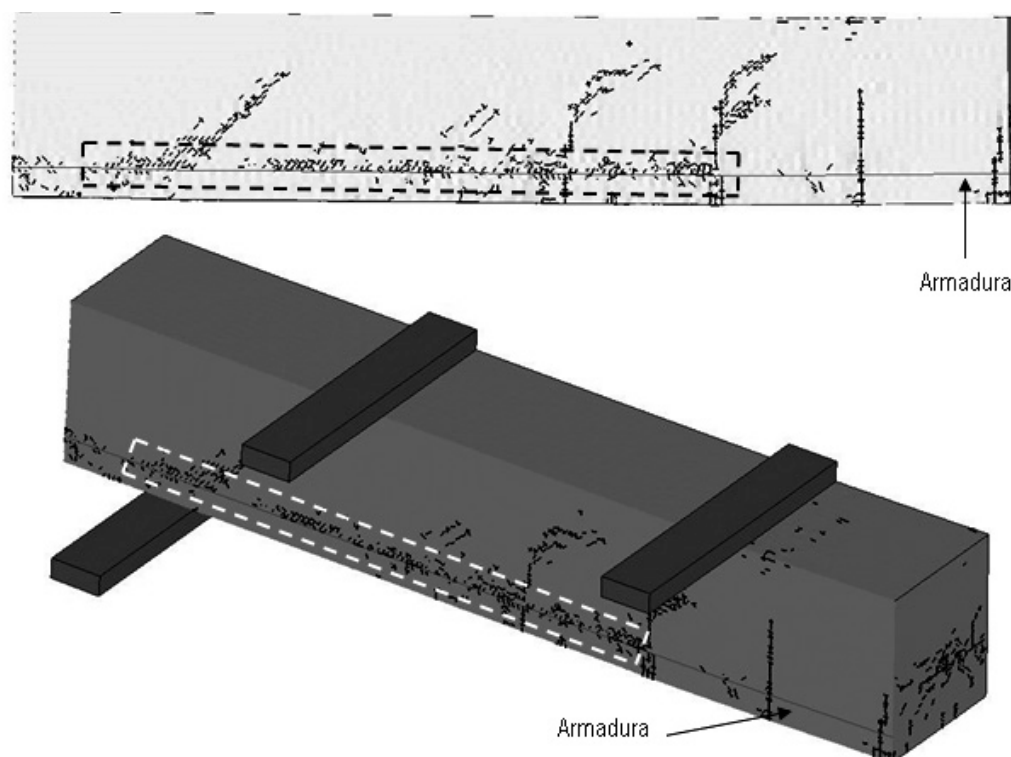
Sección por el eje longitudinal de la viga B100-D3(16) ante carga impulsiva. Obsérvese la existencia de fisuración en los elementos de hormigón adyacentes a la barra de armado
